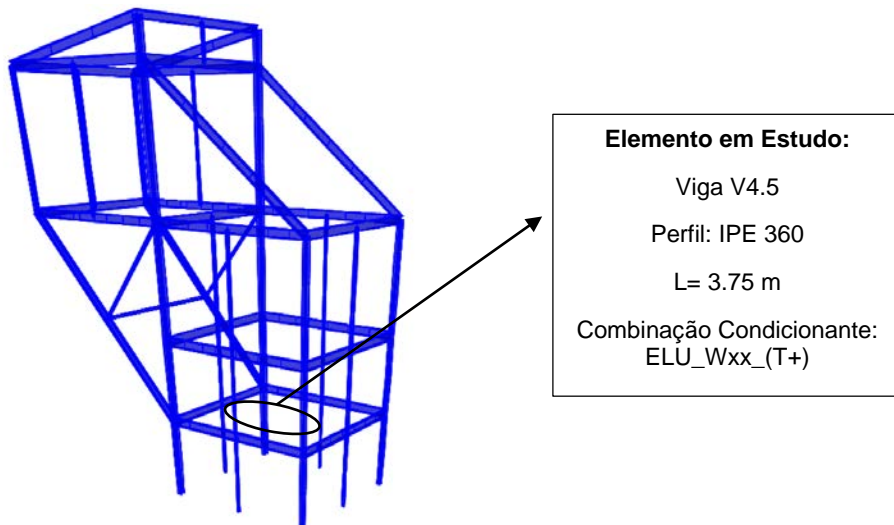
Localização da Viga V4.5 da Travessa do Pórtico 5
